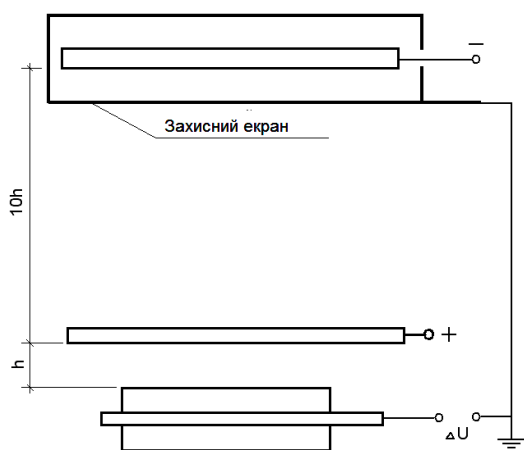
Схема вимірювання потенціалу арматурного стержня неекранованого зразка з захисним екраном на негативному полюсі
